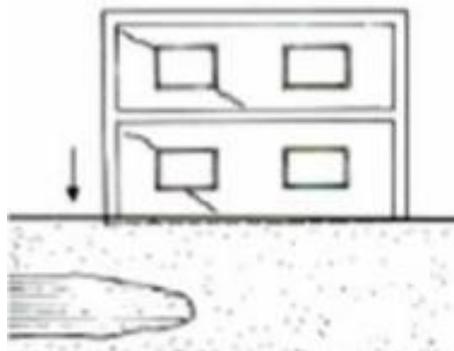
Fissuras pela influência de fundações vizinhas
